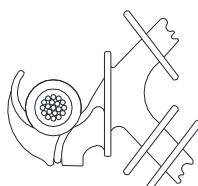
Amarrações e ligações – Amarração do cabo protegido em espaçador monofásico, vertical e losangular – Laço plástico
